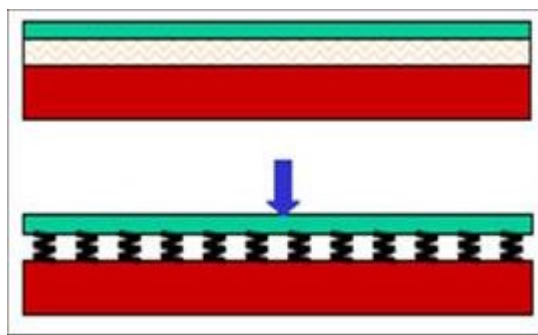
Pavimento galleggiante che si comporta come un letto di molle
